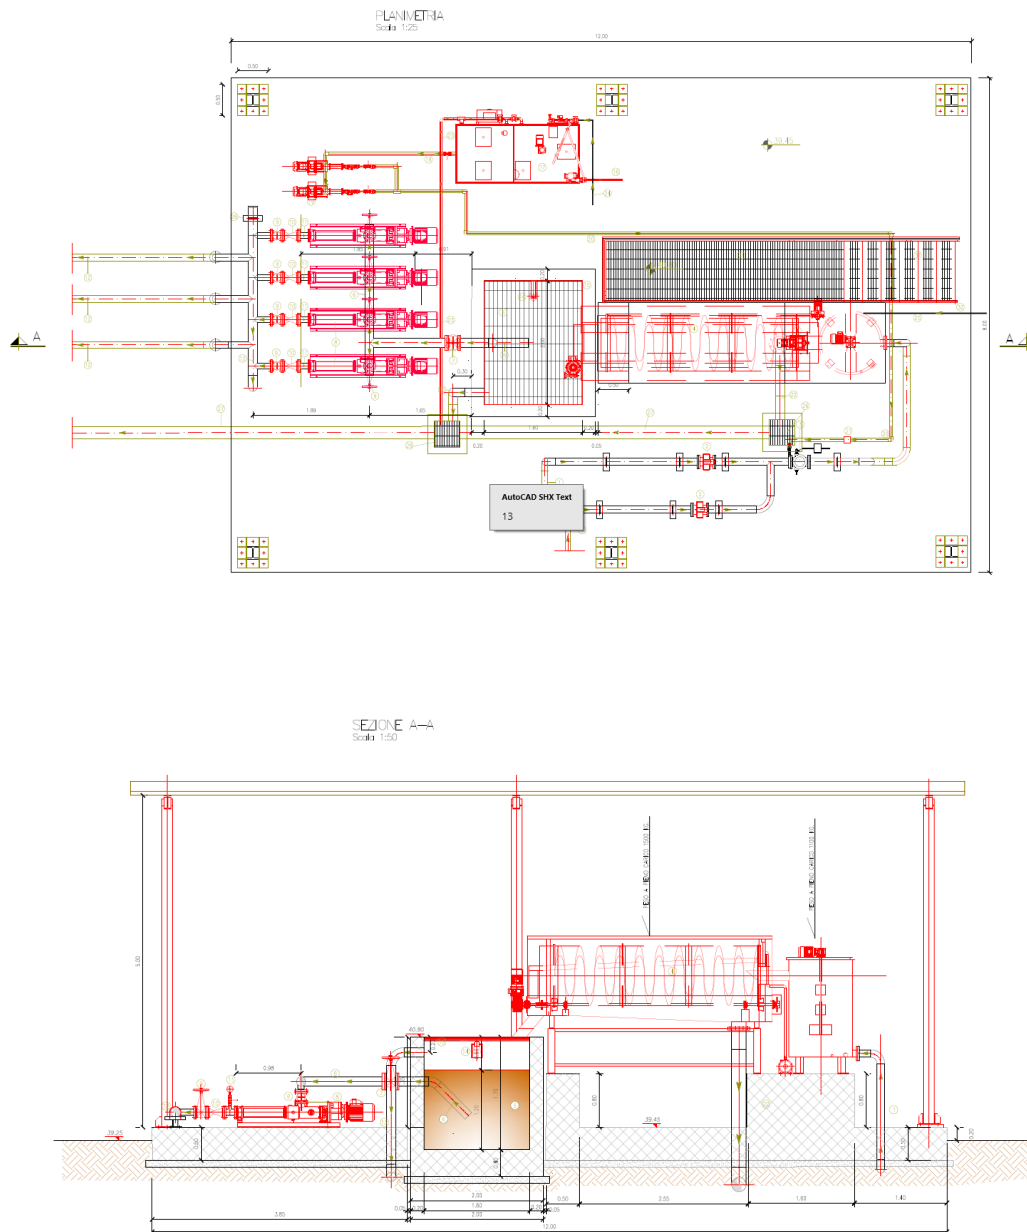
Planimetria e sezione nuovo Preispessitore dinamico
